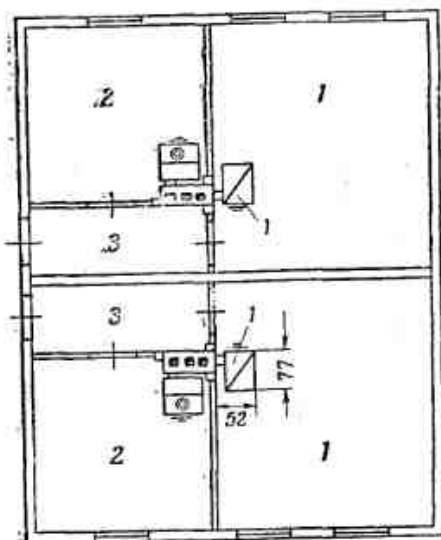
План дома к примеру № 2 расчета печного отопления:
